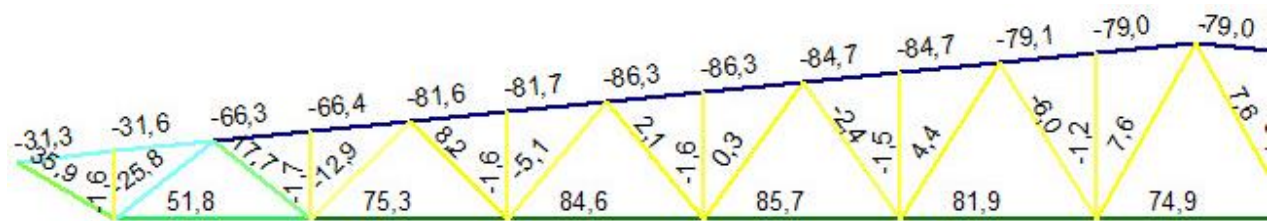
Усилия в элементах фермы пролетом 36 метров при нагрузке 1,3 т/м
